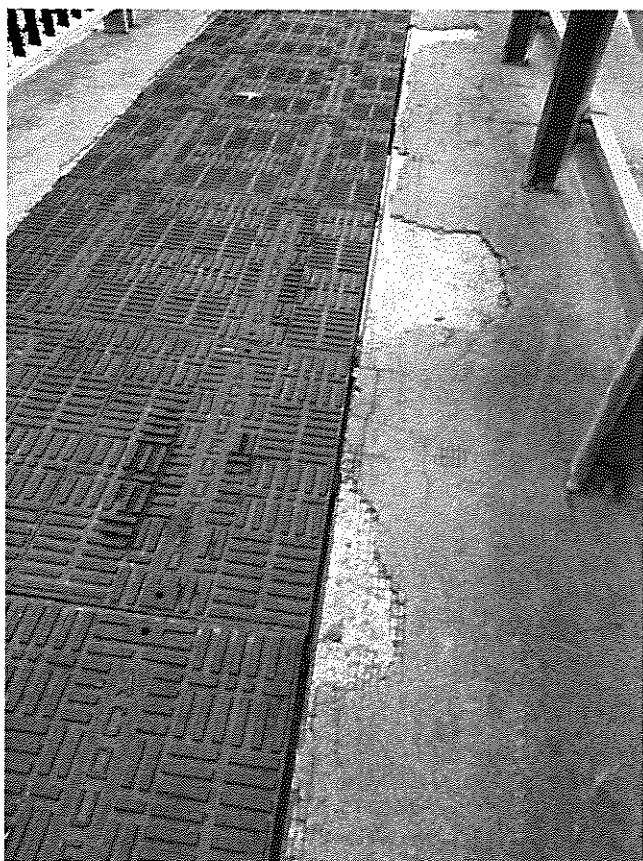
Fessure al perimetro delle lastre e pavimentazione ammalorata al loro contorno
